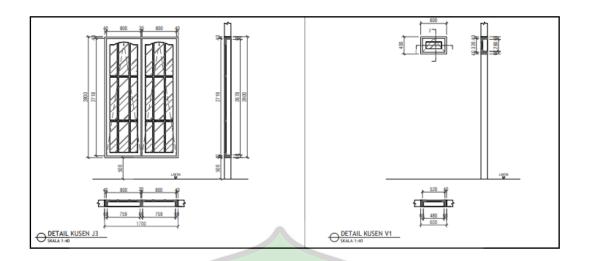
Detail Kusen Pintu Bangunan Utama
